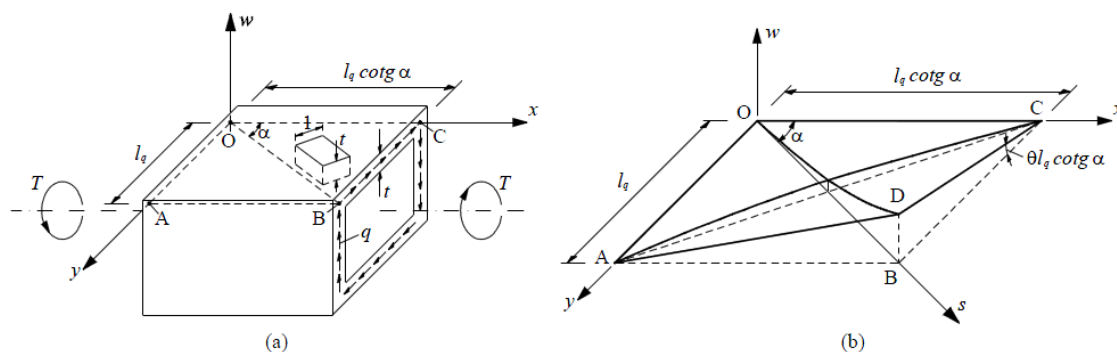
Flexão de uma escora de betão na parede de uma viga em caixão sujeita à torção [9]
